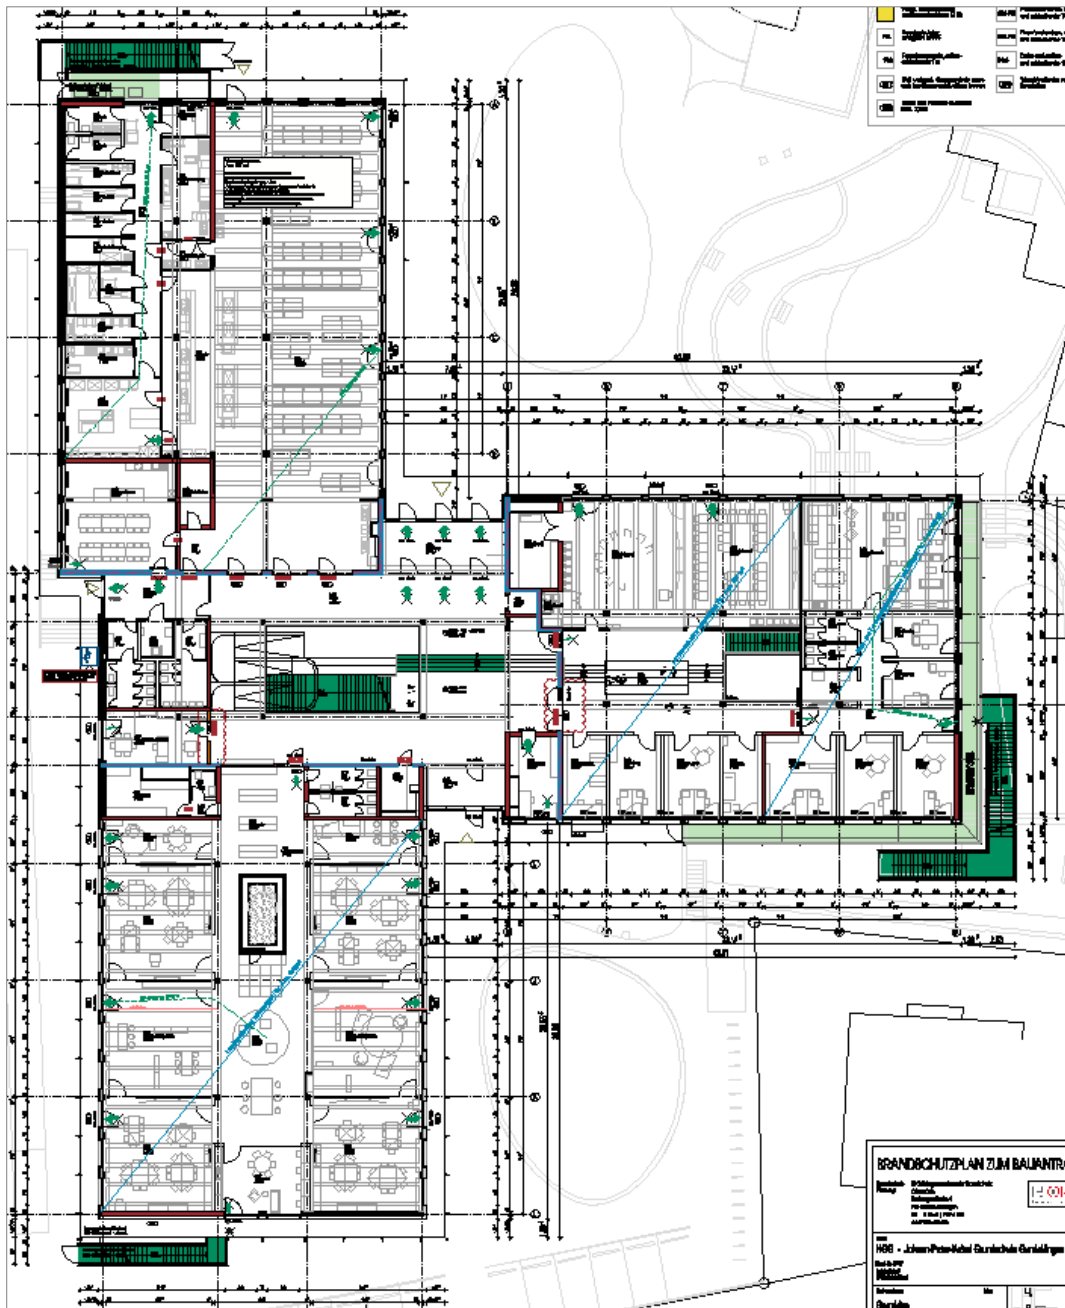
Grundriss EG, ohne Maßstab
